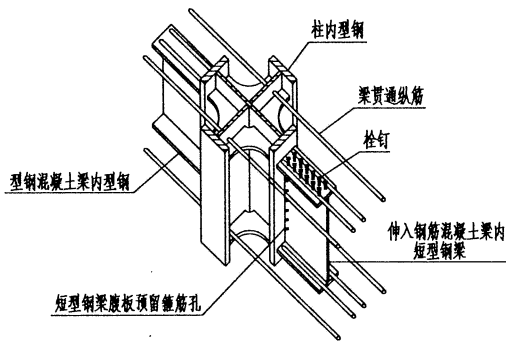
框架节点两侧分别为型钢混凝土梁和钢筋混凝土梁
